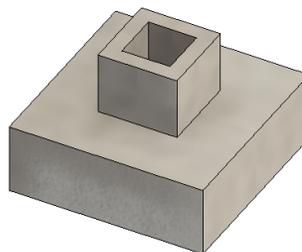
Fundación del sistema estructural. Fuente: Elaboración propia.
